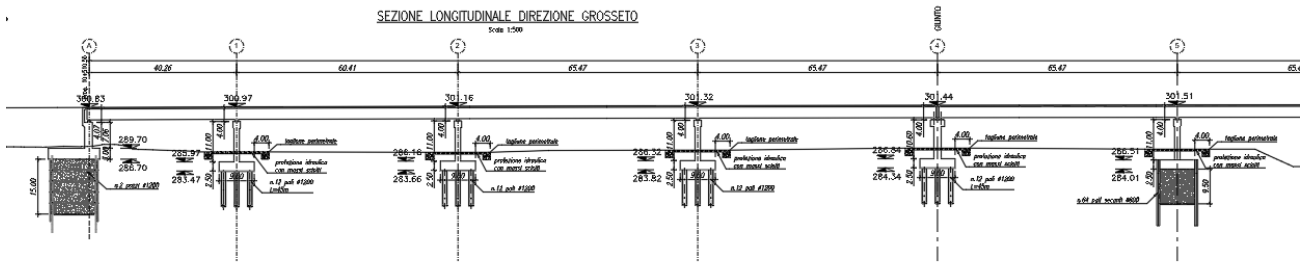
Sezione longitudinale carreggiata direzione Grosseto
